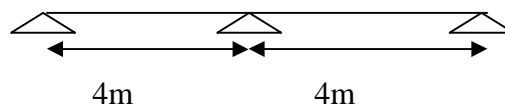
Schéma statique du 1<sup>er</sup> type de poutrelles.
